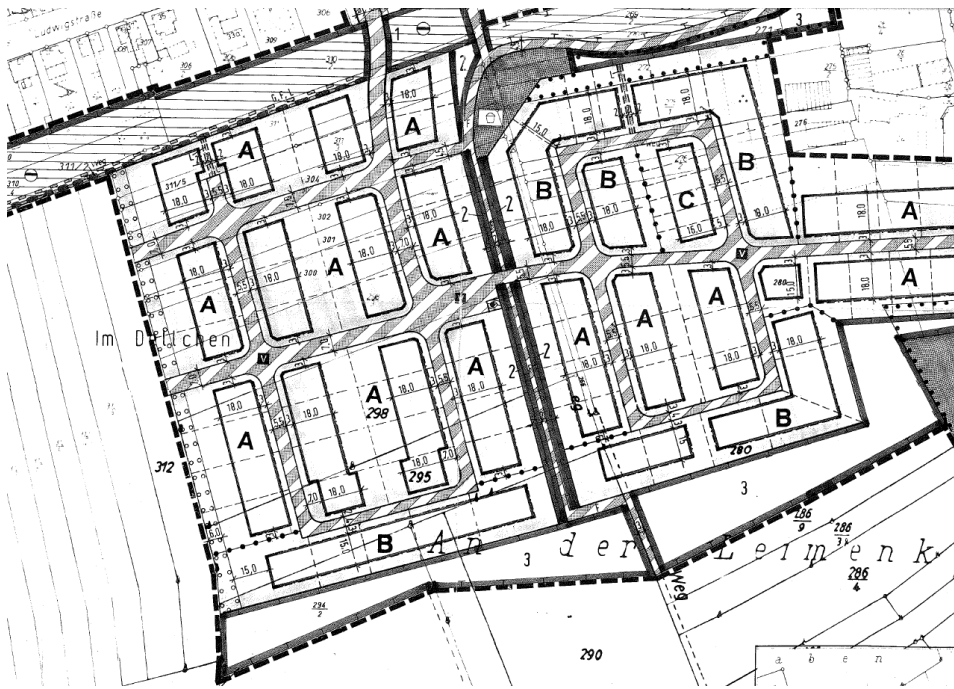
Bebauungsplan „Im Dellchen, 1. Änderung“
